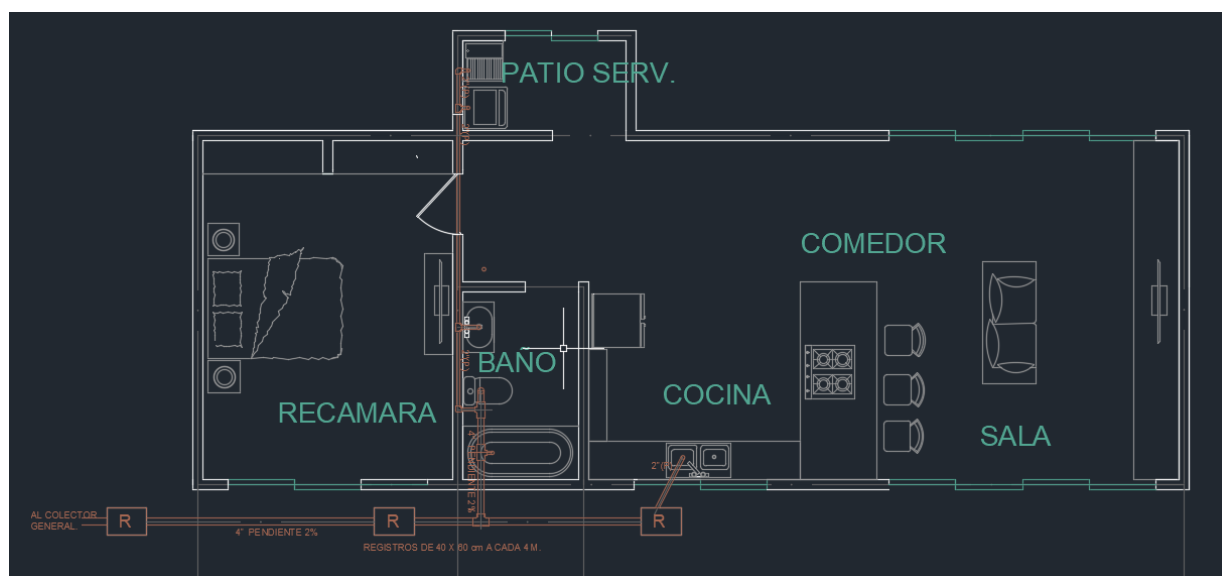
Representación de instalación sanitaria en planta arquitectónica
